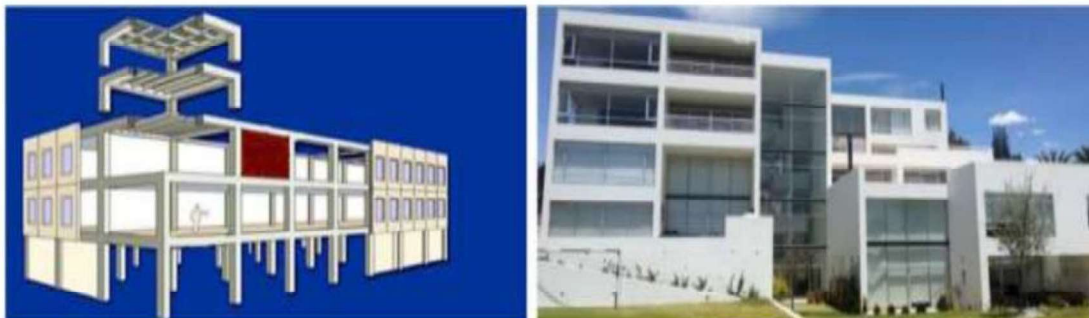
Tipo de sistema estructural: Pórticos de hormigón armado
